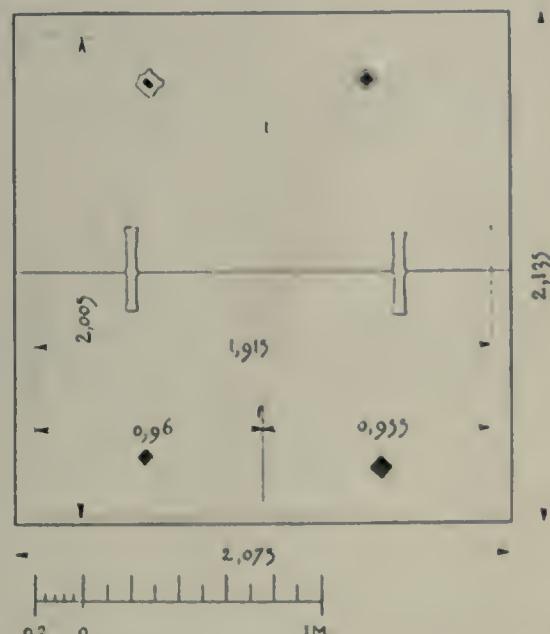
Fondation en avant du trépied de colonne (fig. 196, 11).
